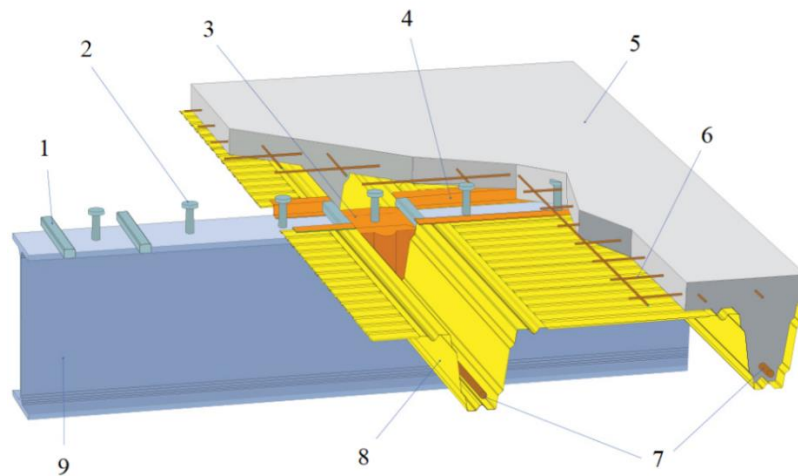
Плита перекрытия по профнастилу TRP200: 1 — стальной опорный элемент; 2 — стад-болт; 3 — пластиковая уплотнительная крышка; 4 — зигзагообразный профиль; 5 — железобетонная плита; 6 — арматурная сетка; 7 — продольная рабочая арматура плиты; 8 — стальной трапециевидный профнастил TRP200; 9 — стальная балка
